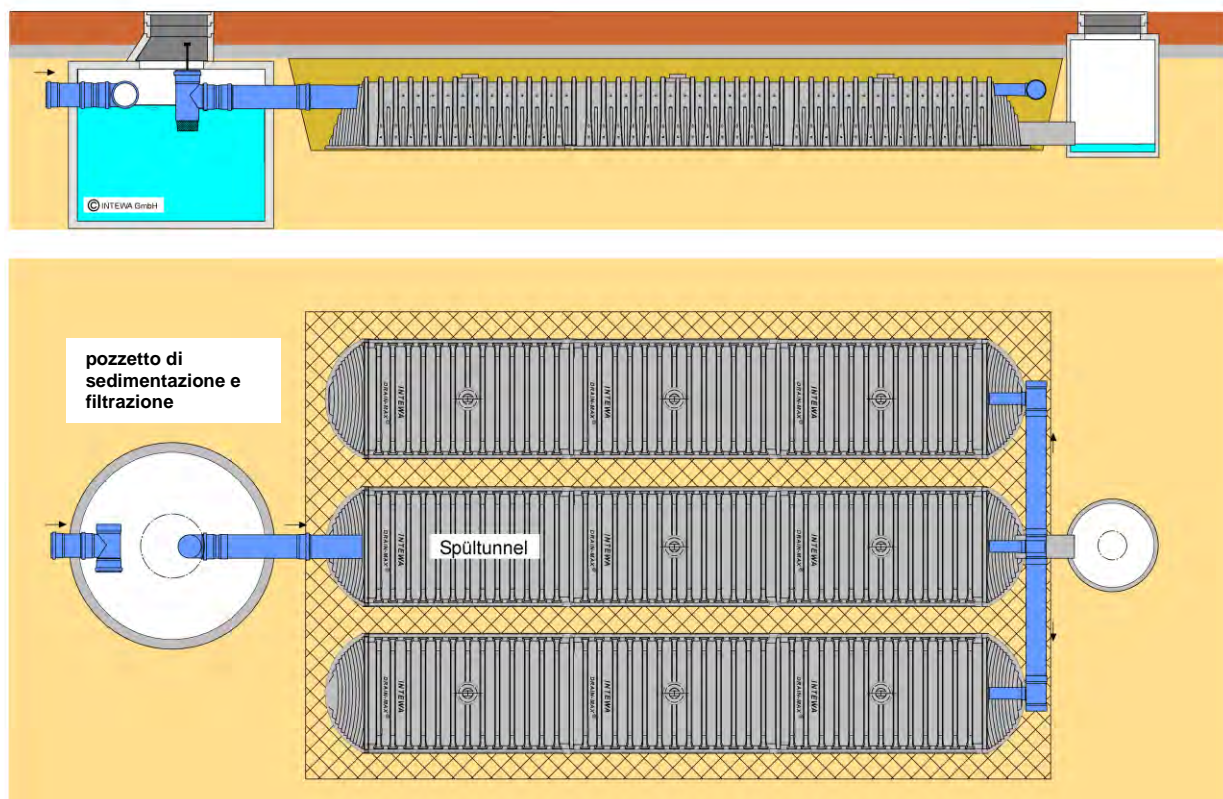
Esempio per il collegamento in entrata delle file di tunnel parallele utilizzando un tunnel di lavaggio
